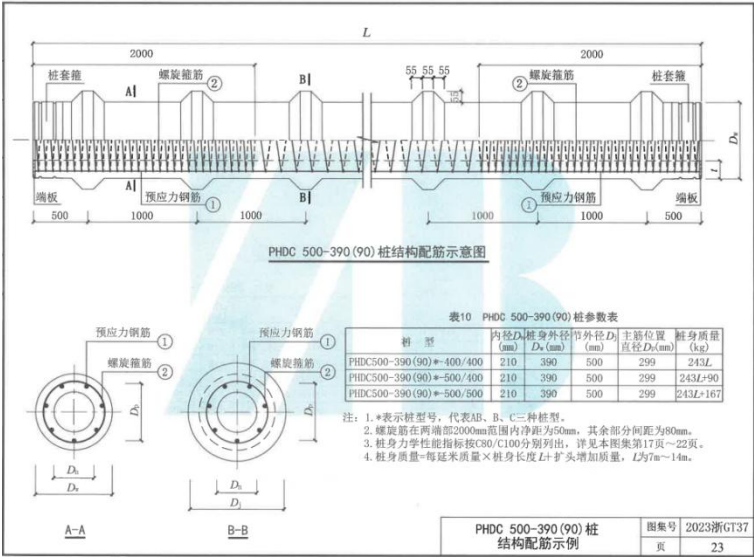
静钻根植桩结构配筋示意图 (以500-390为例)
